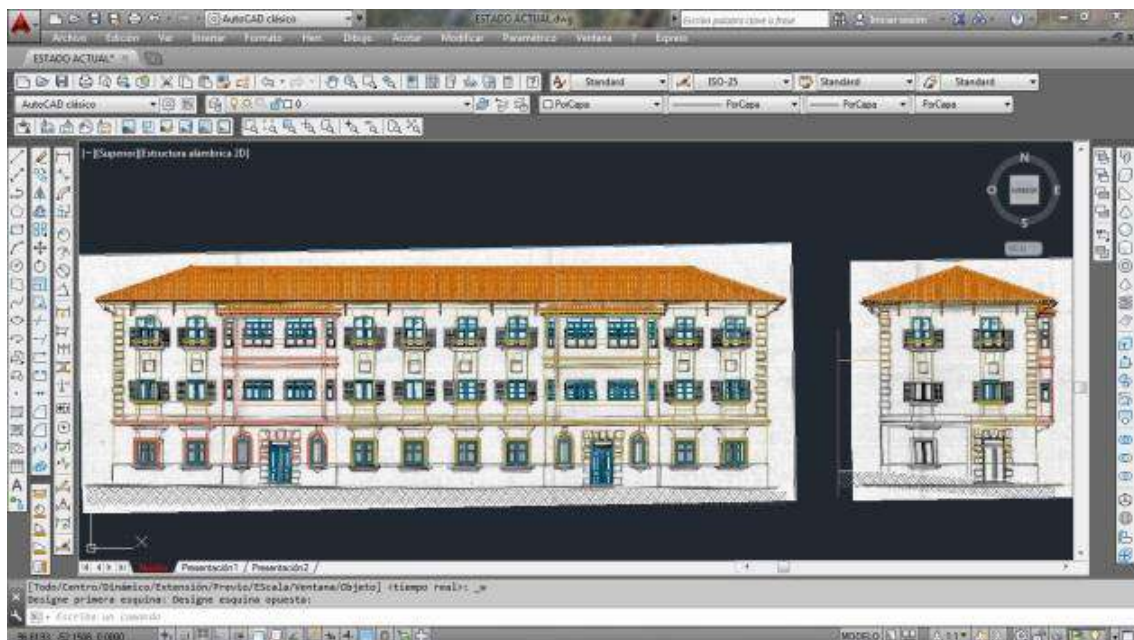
Proceso de Levantamiento de las Fachadas en Autocad. 2016. Fuente propia.
